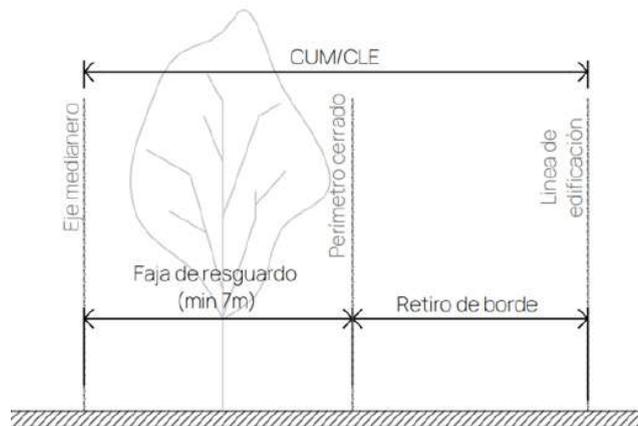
Perfil faja de resguardo colindante con ejes medianeros por fuera del perímetro cerrado.
